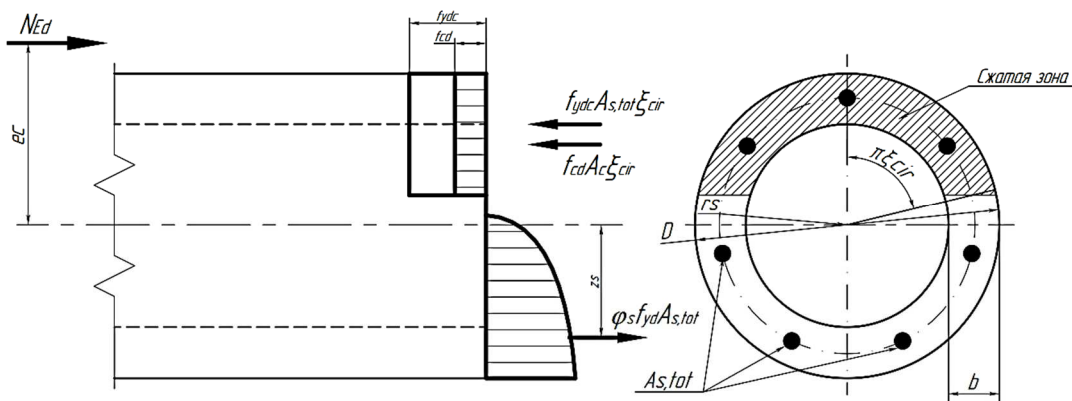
К расчету кольцевого сечения внецентренно сжатого железобетонного элемента [16; 17]
